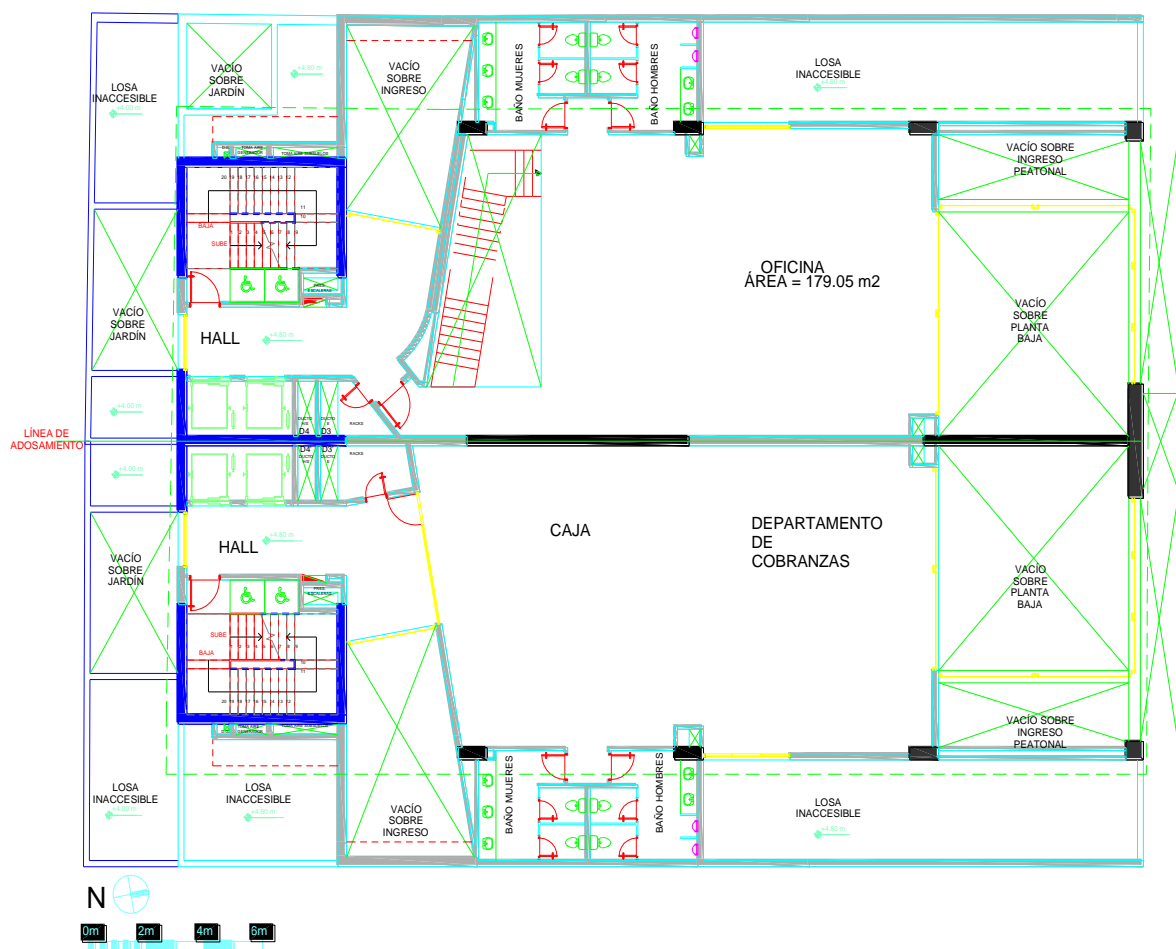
Planta Mezzanine: Bloque 1 y 2
